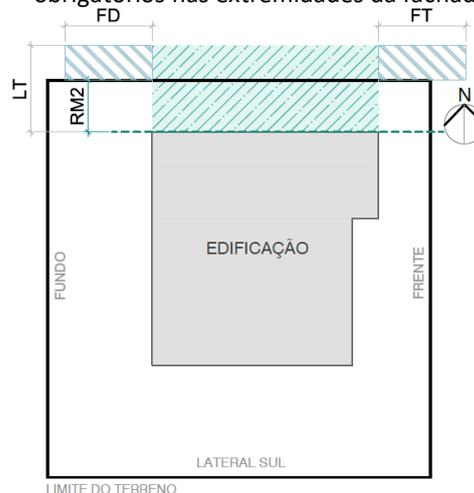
Planta esquemática dos recuos obrigatórios nas extremidades da fachada norte
